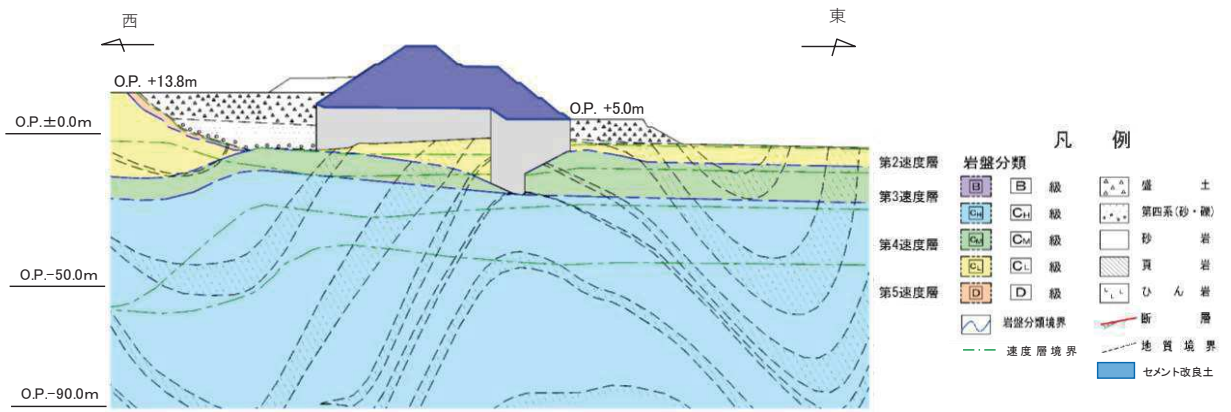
セメント改良土の配置図（防潮堤（盛土堤防），断面①）
